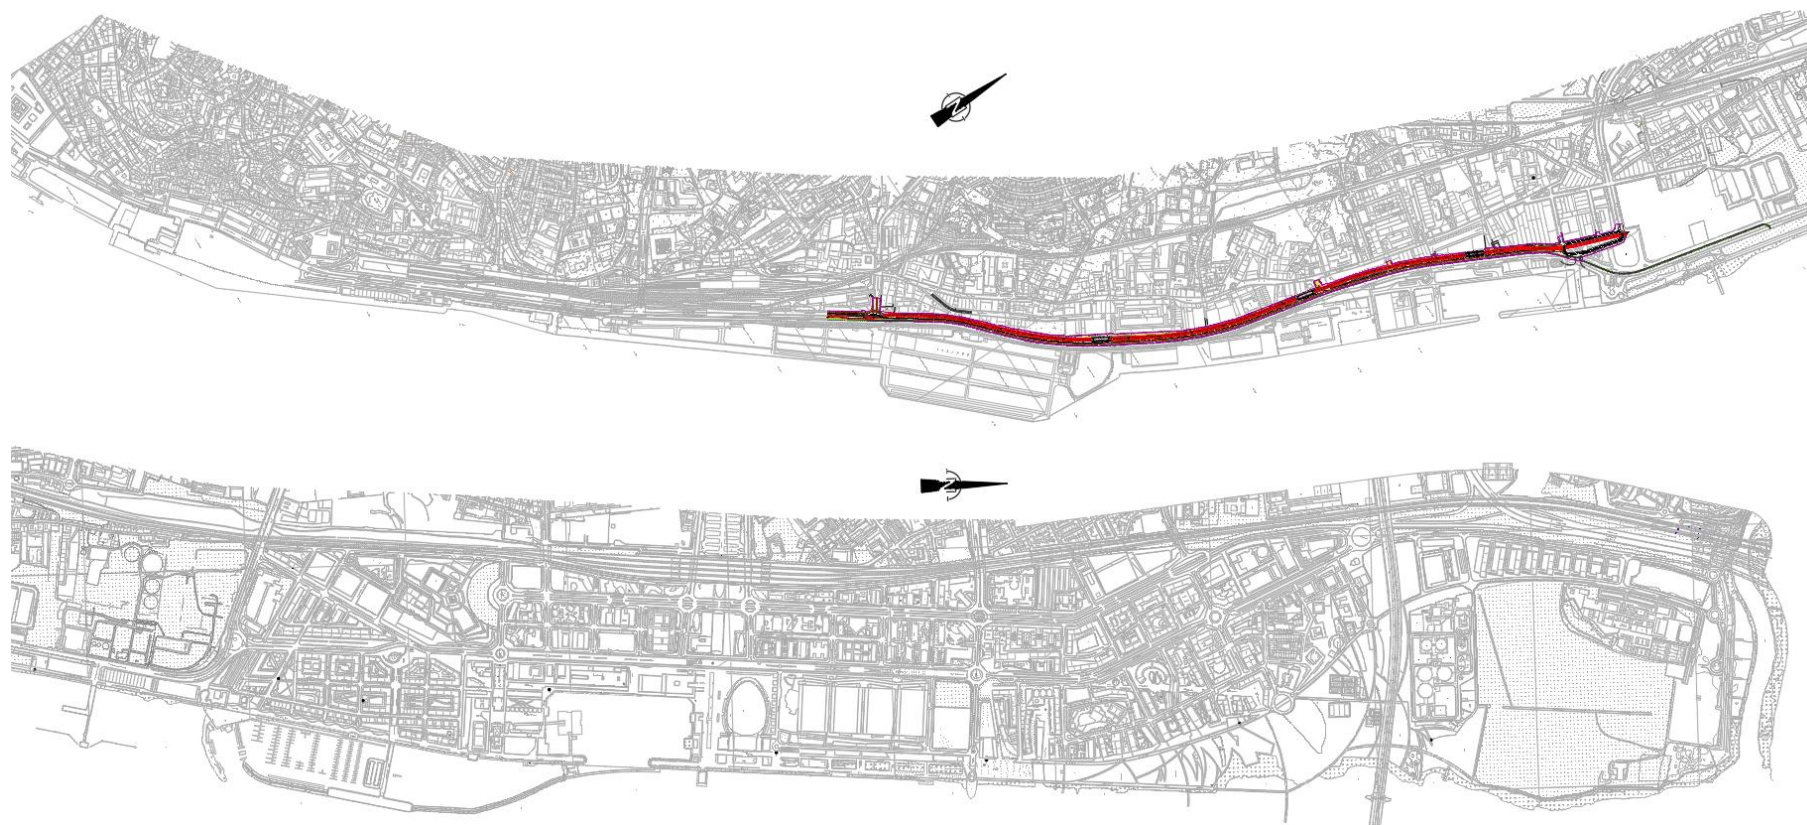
Desenvolvimento da Alternativa 2A (em planta)
